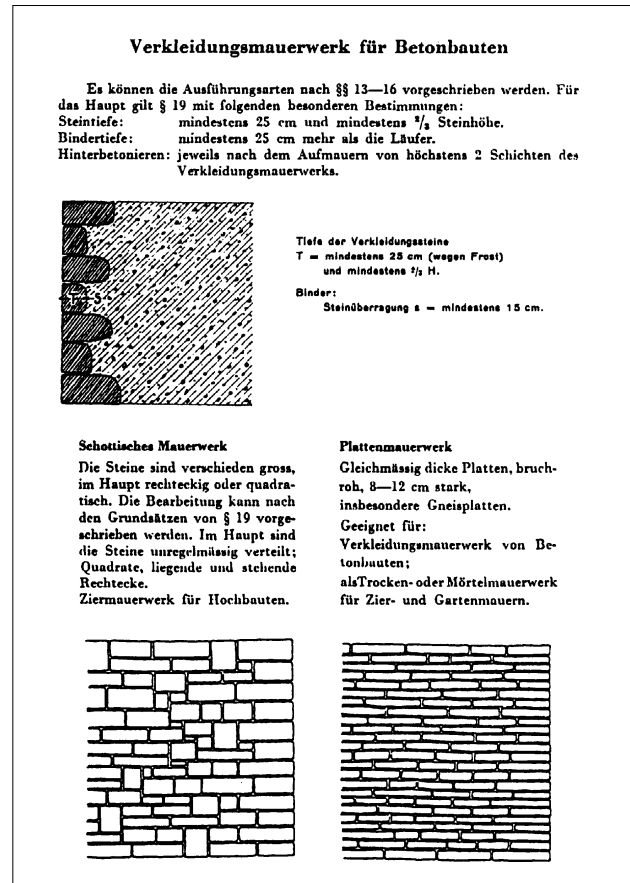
Verkleidungsmauerwerk für Betonbauten, aus [7.10]
